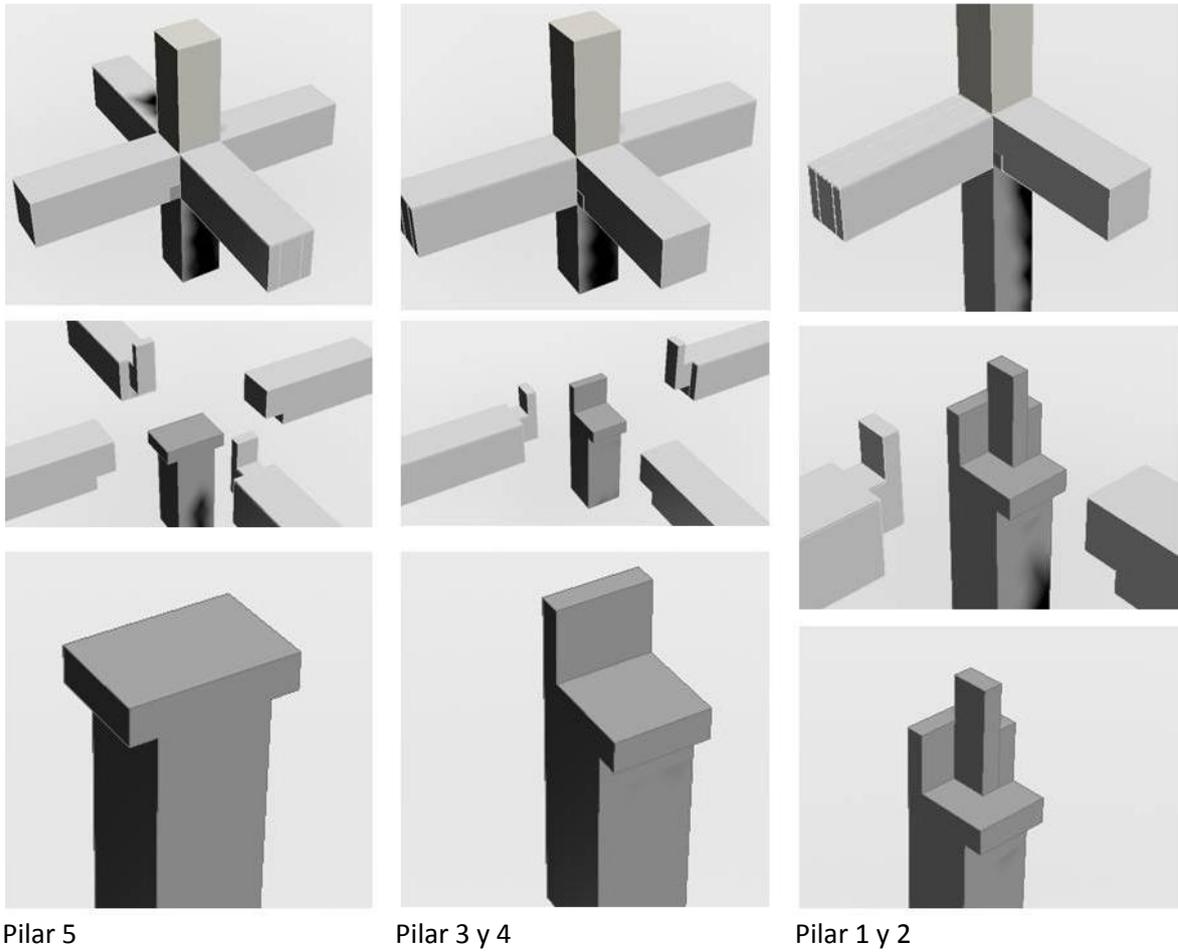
Tipos de uniones estructurales de pilares y vigas.
